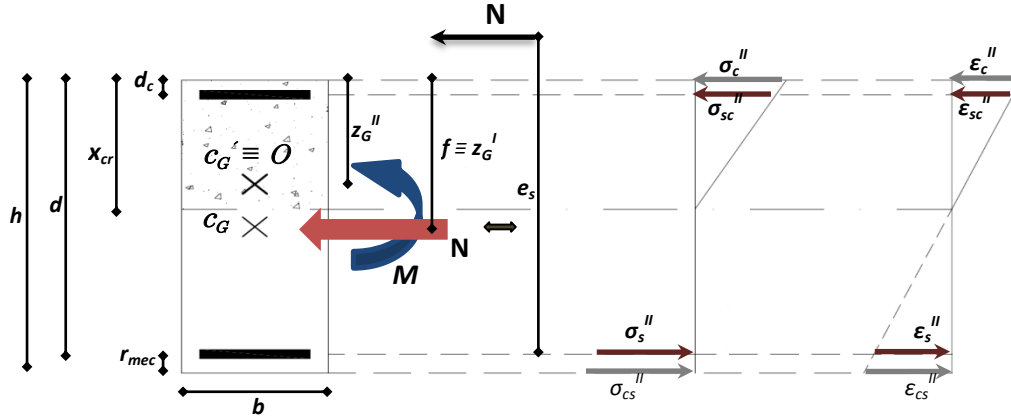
Modelo de cálculo de secção rectangular em estado fendilhado
